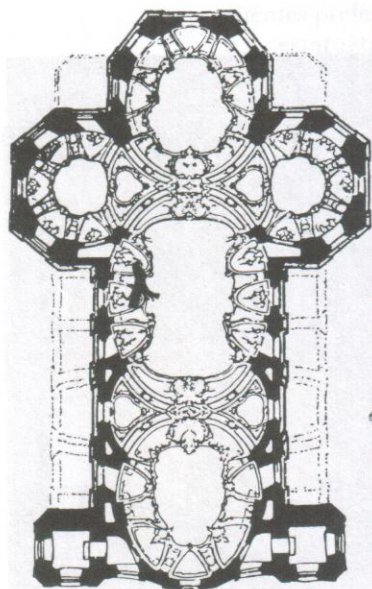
Planta da igreja de Vierzehnheiligen.
